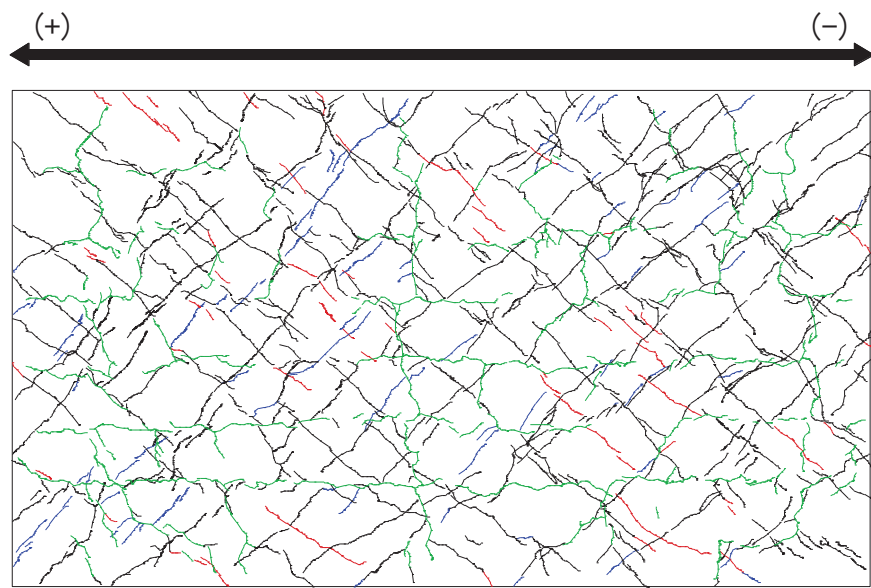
(11) 乾燥試験体 [2] $1/250\text{rad.}$ におけるひび割れ図
